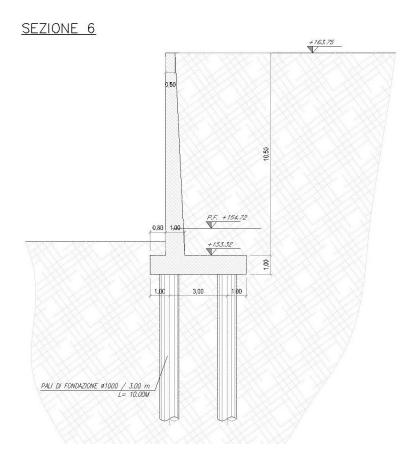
Sezione del manufatto oggetto della presente relazione di calcolo.
